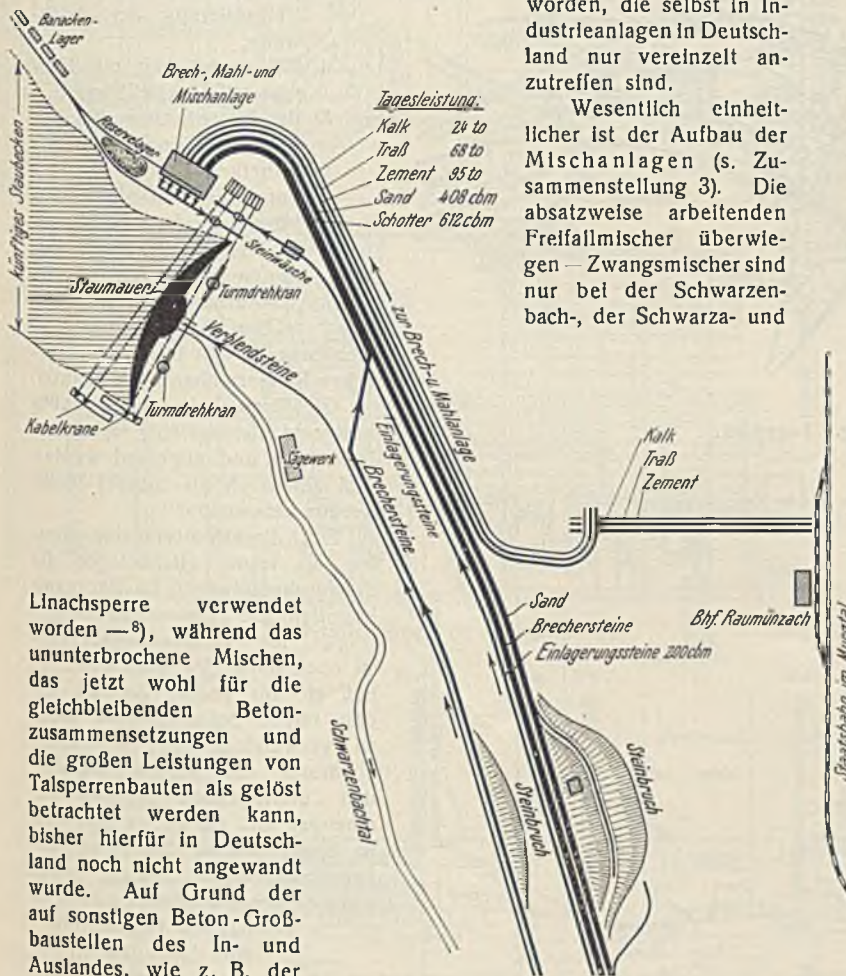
Schwarzenbachtalsperre. Baustellen-einrichtung. Lageplan.
